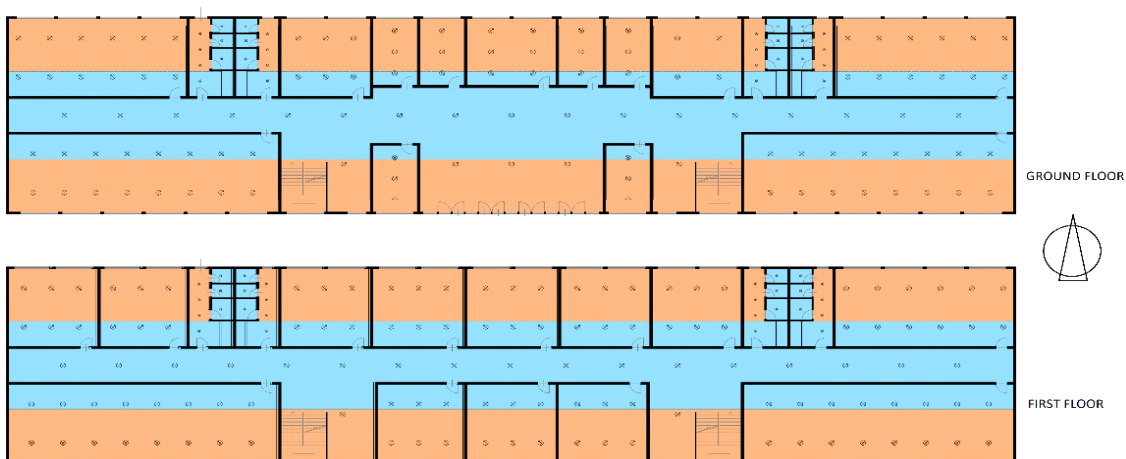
Planimetria del piano terra e del piano tipo con indicazione, per ciascun locale, delle aree AD (arancio) e AND (azzurro) e posizionamento degli apparecchi.
